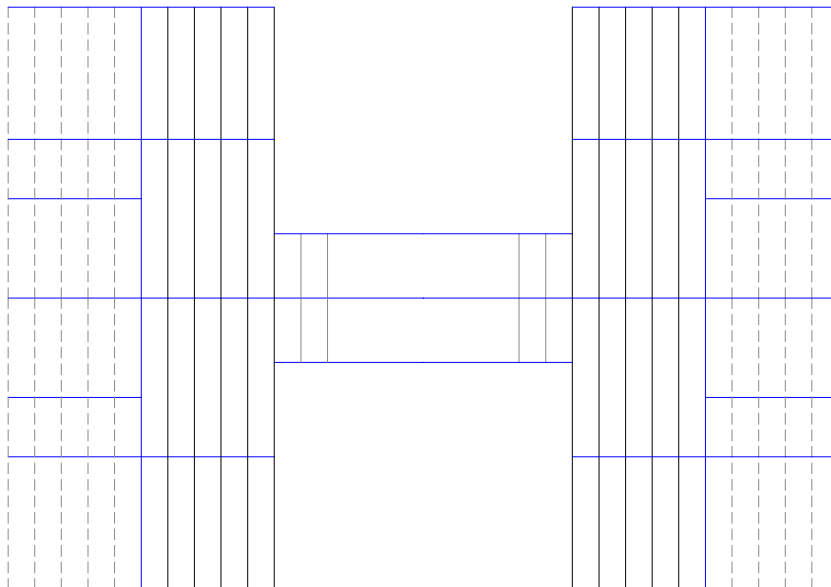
Posicionamento das vigas nos modelos B-4-600.
